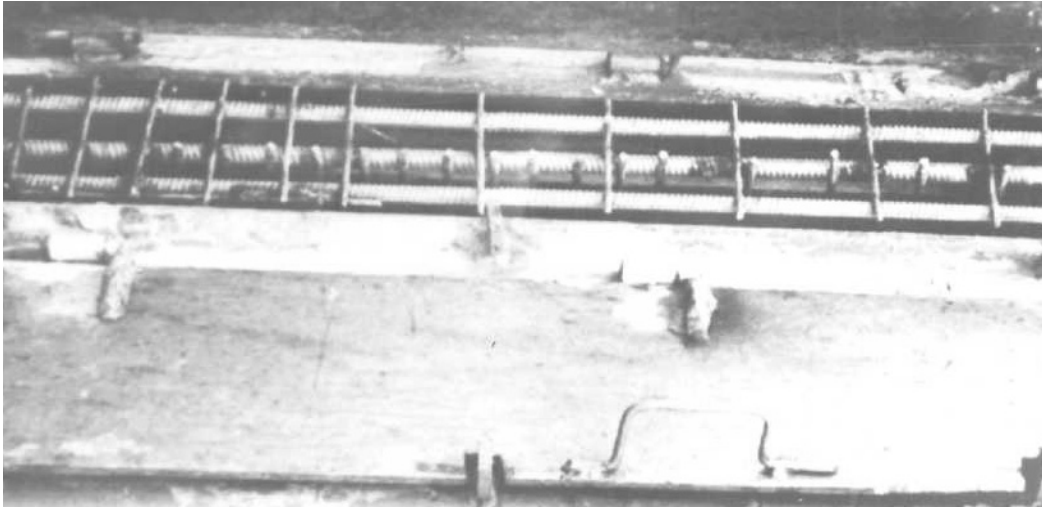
Опалубка і арматурні каркаси перед бетонуванням
